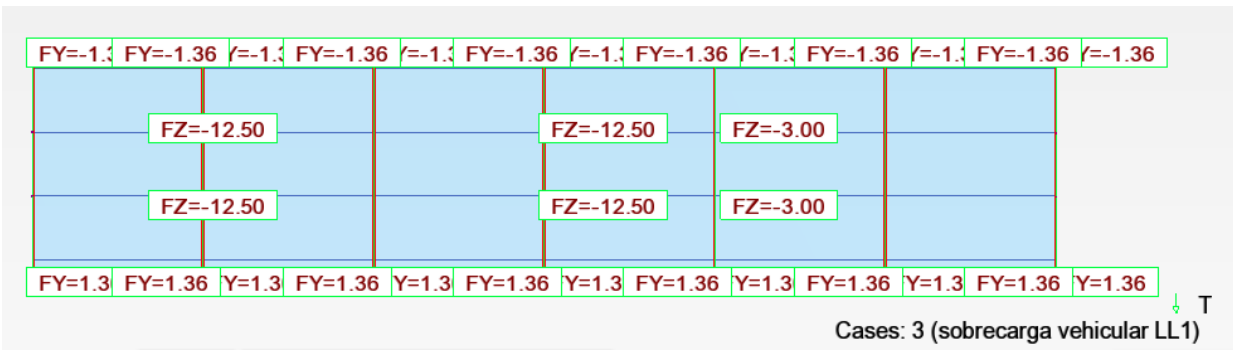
Vista en planta - Carga tipo MOP MODIFICADA
